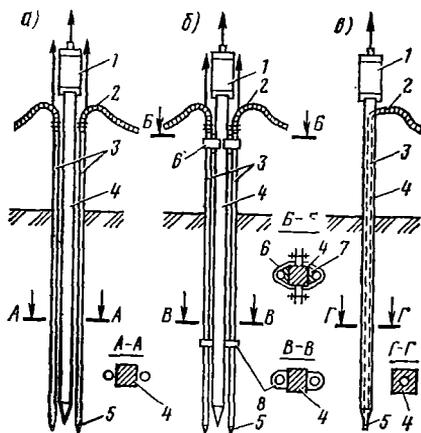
Схема расположения подмывных труб в сплошных сваях:
